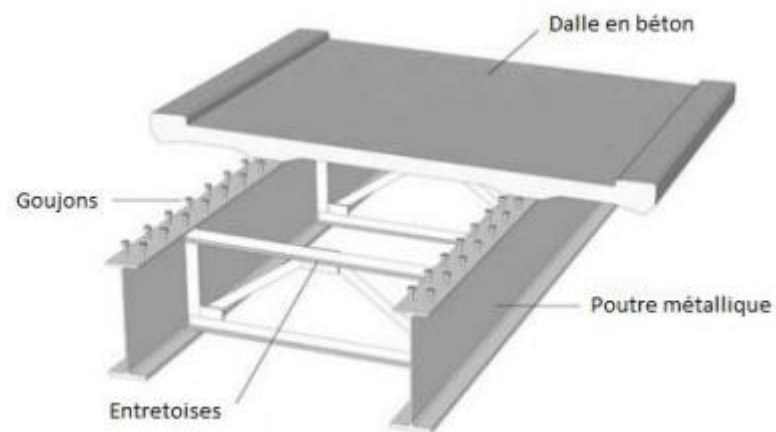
Connexion entre les poutres métalliques et la dalle
